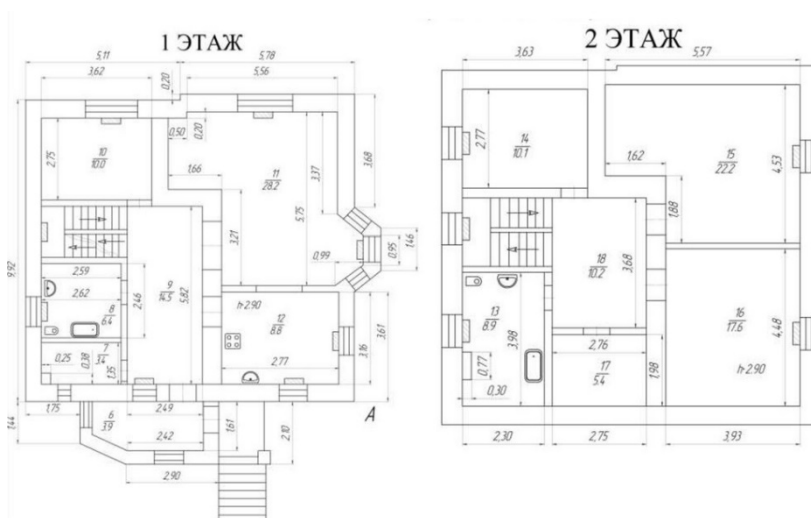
Пример расположения нескольких этажей на поэтажном плане
